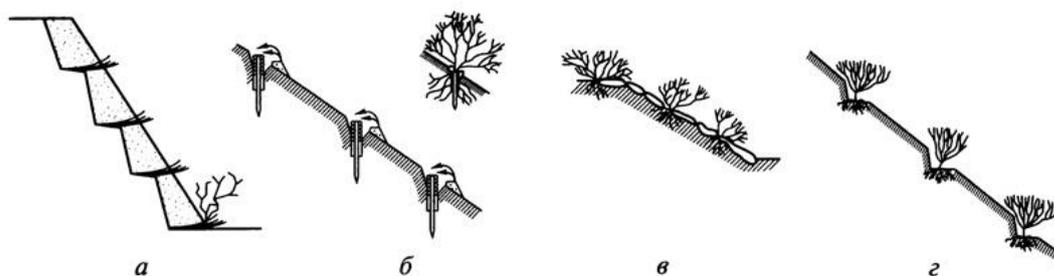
Укрепление откосов посадкой кустарников: а — горизонтальная укладка черенков; б — посадка с использованием плетней; в — закрепление камнем; г — посадка на ступенчатых выемках
